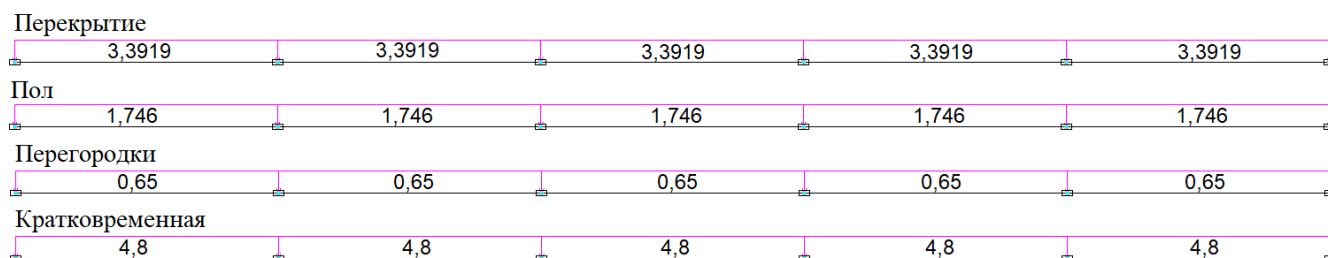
Нагрузки на перекрытие на стадии эксплуатации
